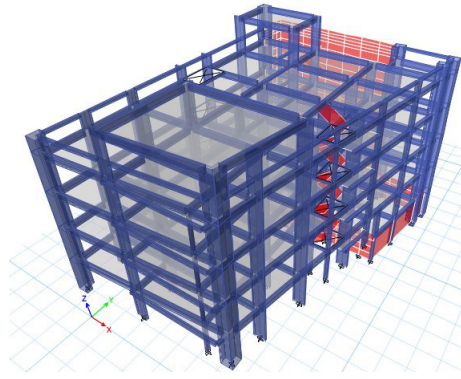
Estructura 3D del Centro de Salud de Conchopata
